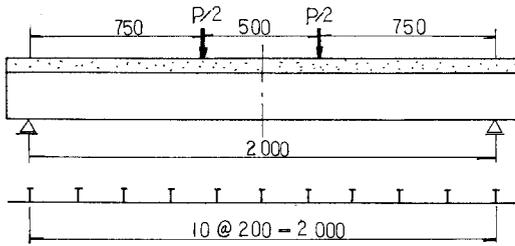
試験体の形状、寸法および載荷位置 (単位 mm)
